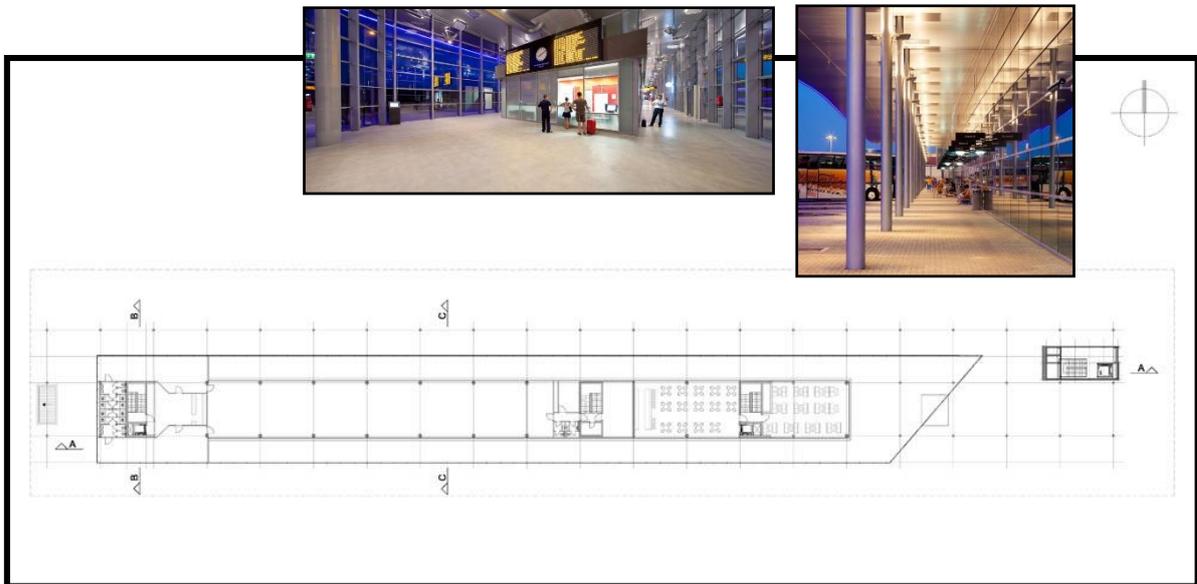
Planta Baja del Terminal de Buses de Osijek
